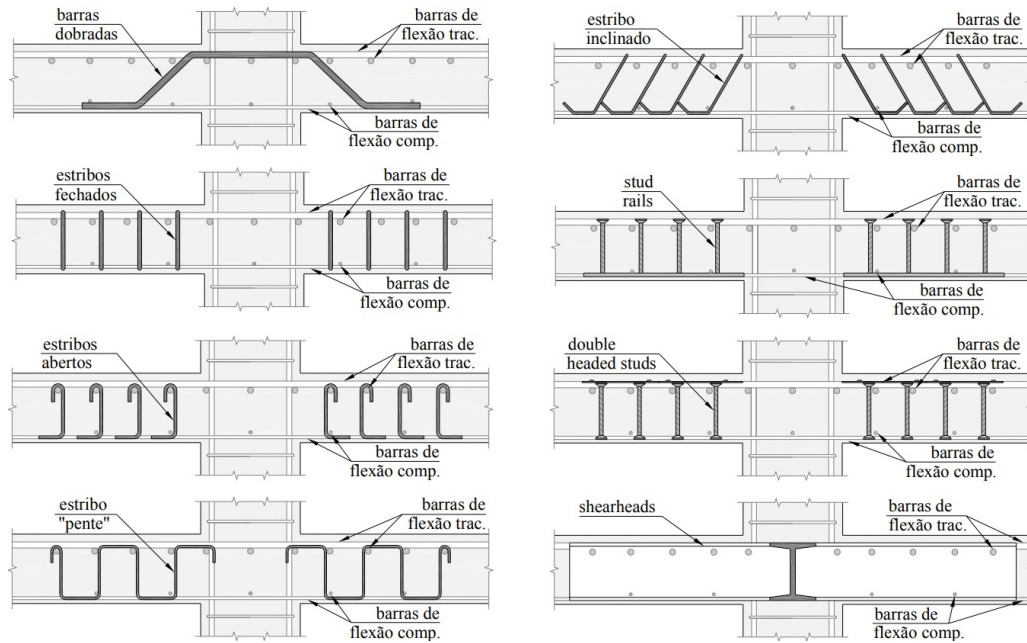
Tipos de armadura de cisalhamento (fonte: Ferreira (2010))
